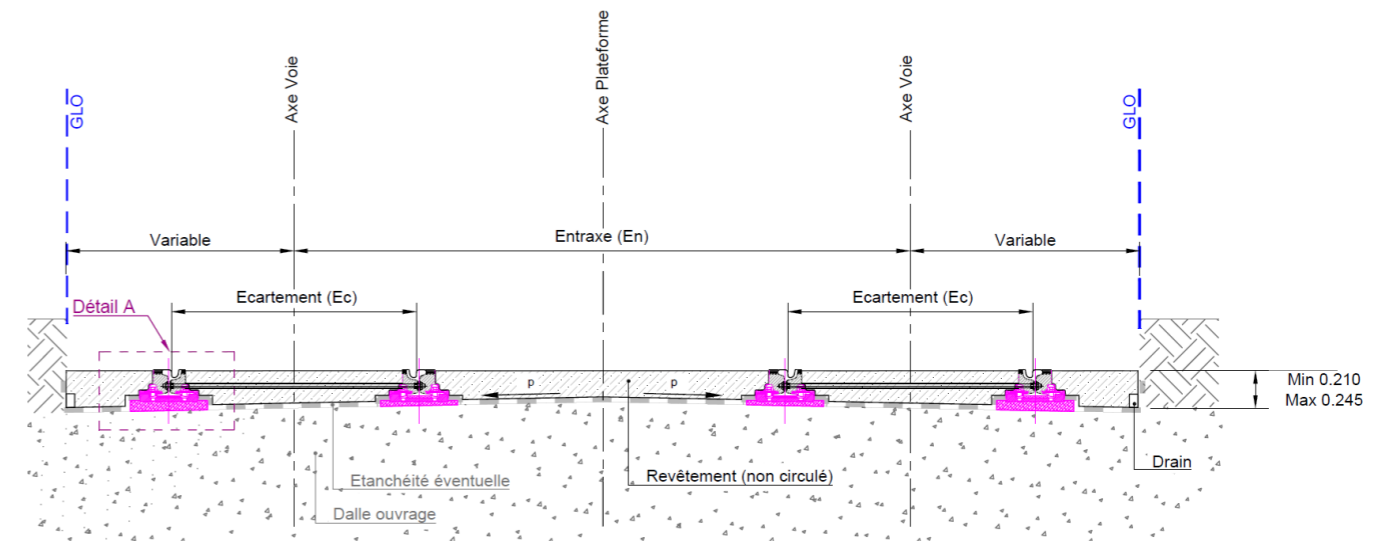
coupe type d'une plateforme pour voie sur selles collées par résine sur ouvrage
